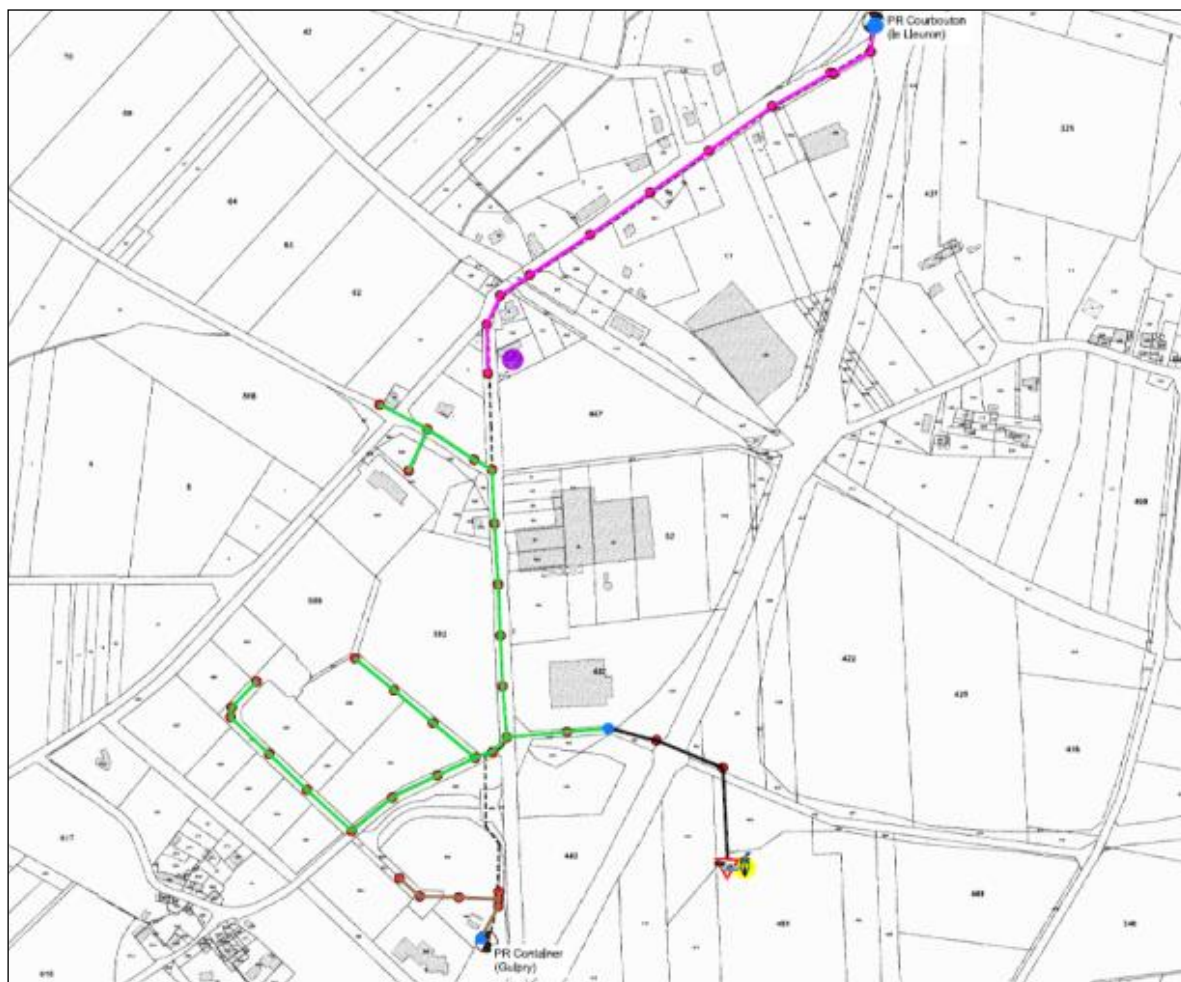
Plan du réseau d'assainissement de Courbouton - Guipry
